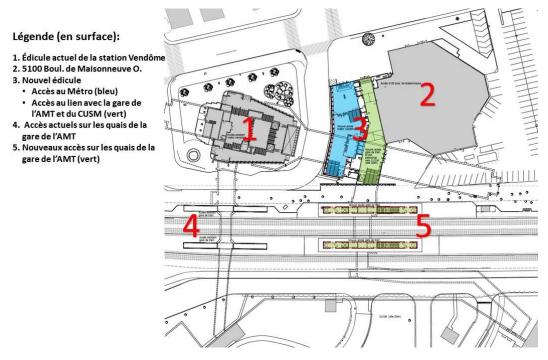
Plan du projet au niveau du rez-de-chaussée
